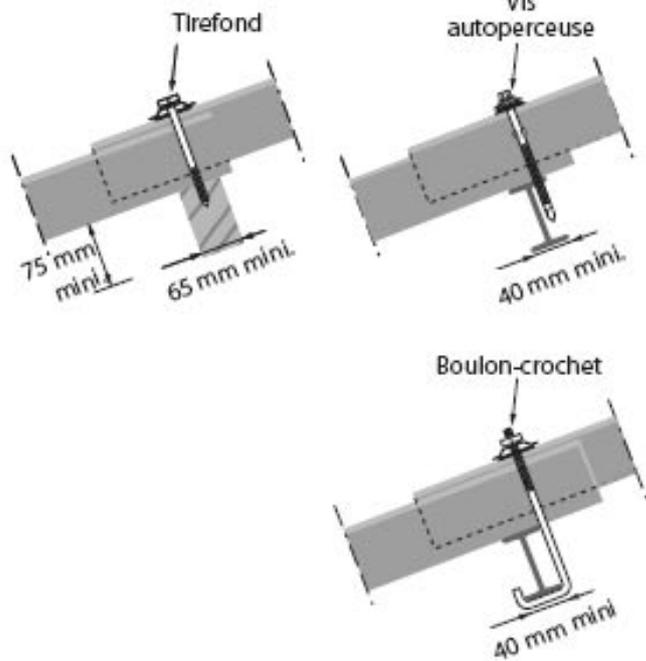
Pose et fixation des plaques Soutuile 190 FR
